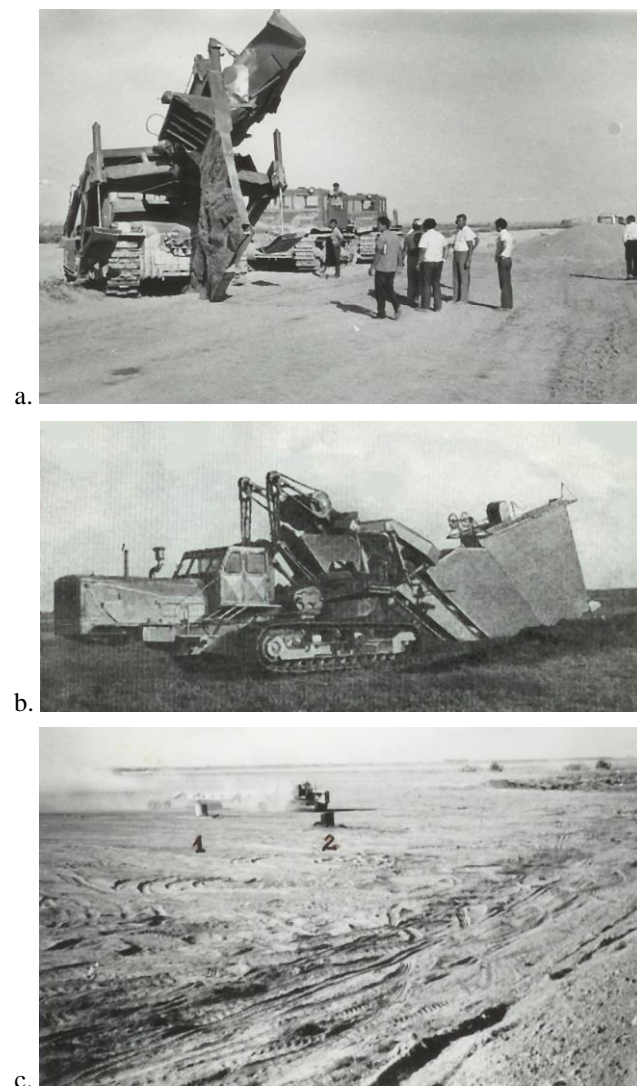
(foto). Drenaj orizontal executat complet mecanizat: a – utilaj complex pentru execuția drenajului orizontal; b – mașină de drenaj D 659 A, în lucru; c – cămine de control pe drenurile colectoare
